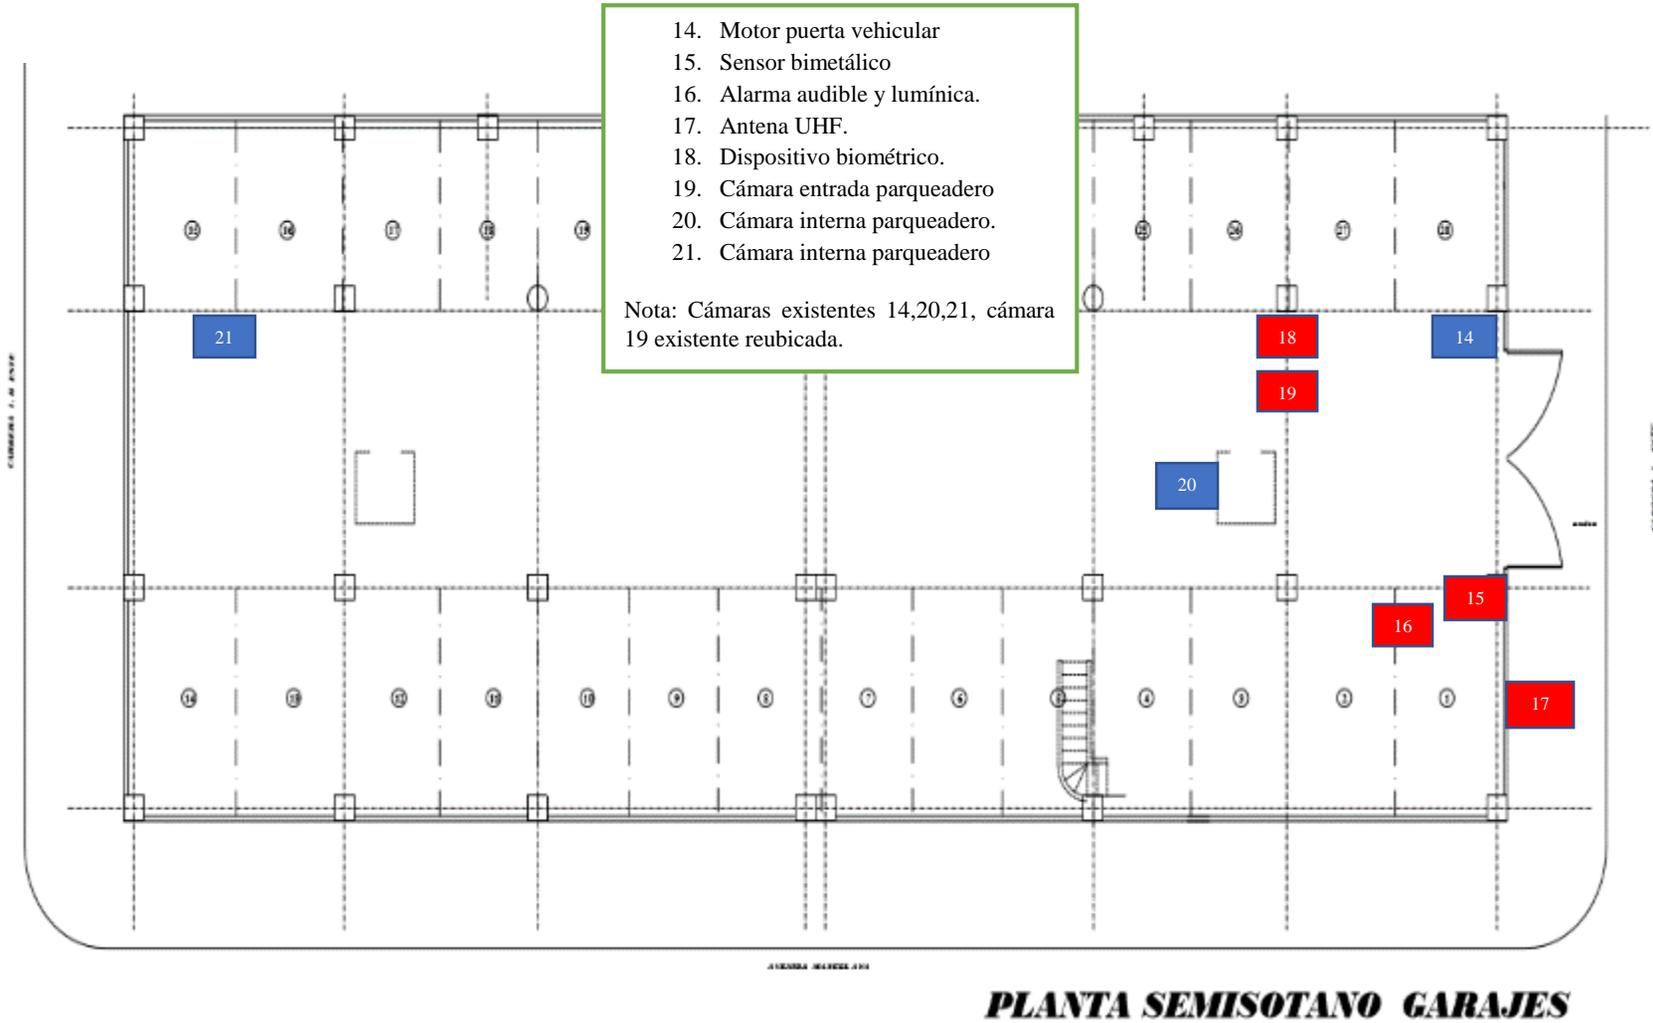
Cámaras existentes y dispositivos a instalar en parqueaderos
